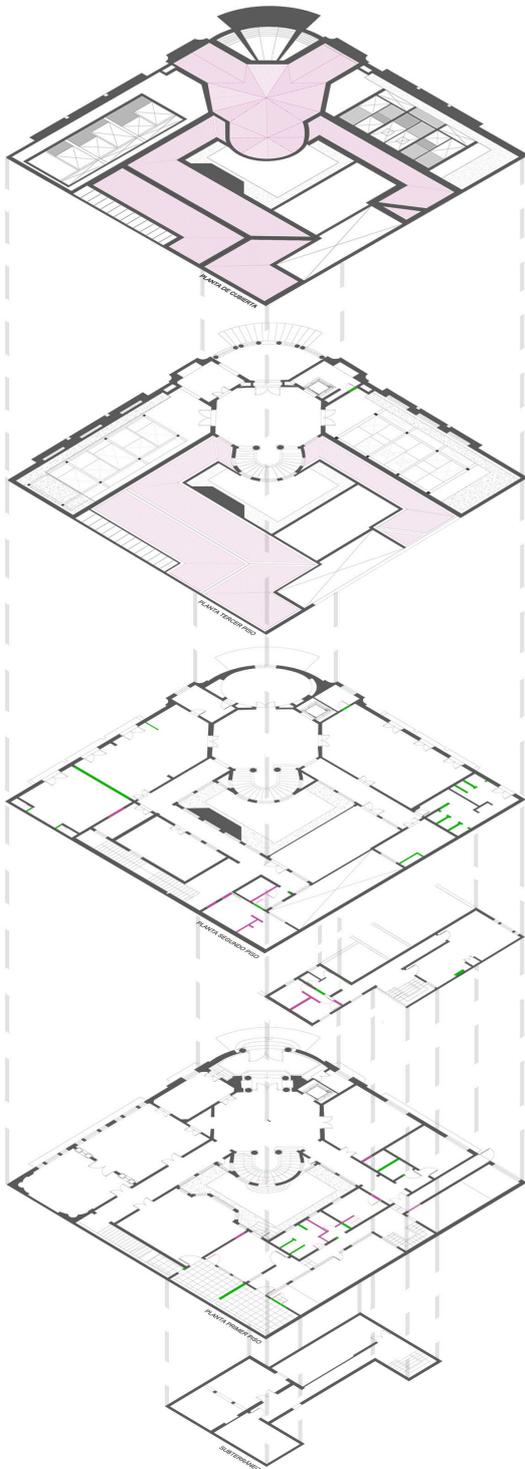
Planimetrías elaborada en base a las intervenciones que se le han realizado al inmueble a lo largo de los años. Elaboración propia, 2022
